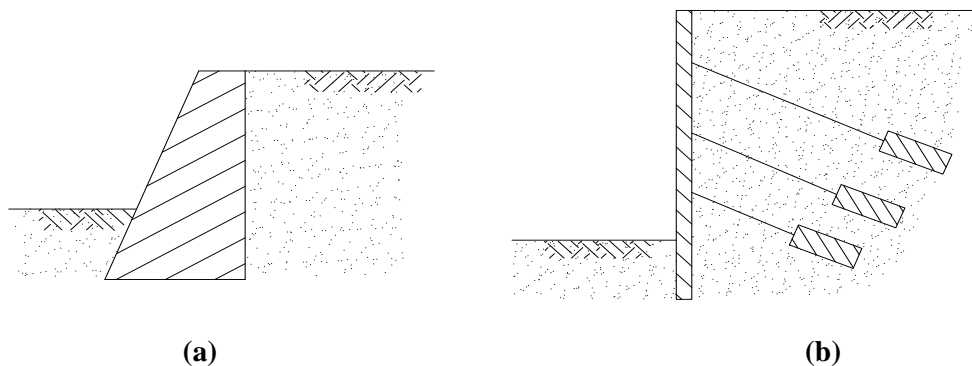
Tipos de estructuras de retención (a) Muro de gravedad, (b) Tabique o muro flexible.
